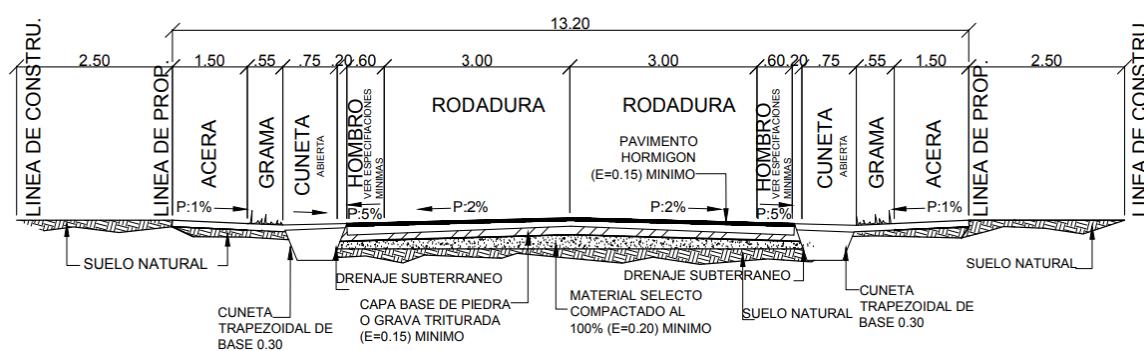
Detalle de calle de 13.20 metros. Fuente: Plano de anteproyecto
